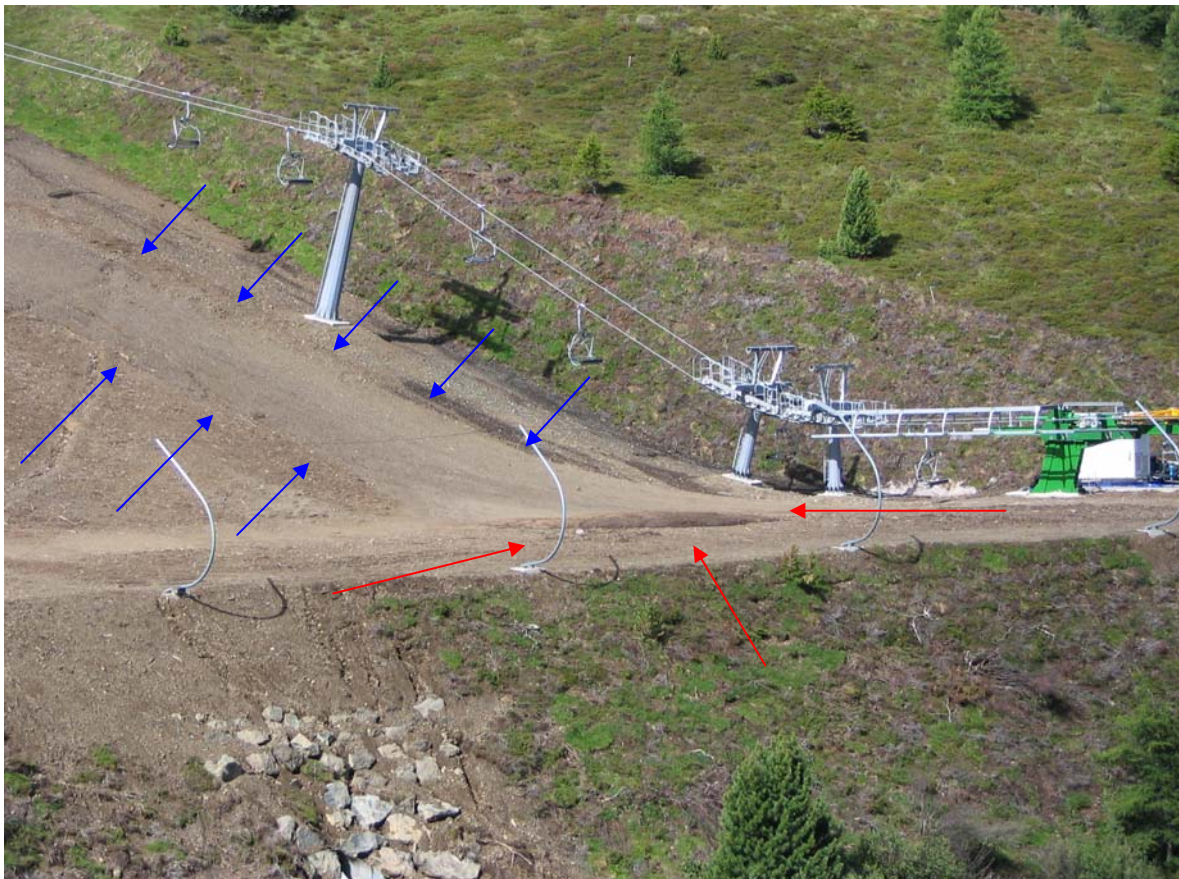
2/7/2005 Particolare della zona di deposito finale loc Svarvazen
